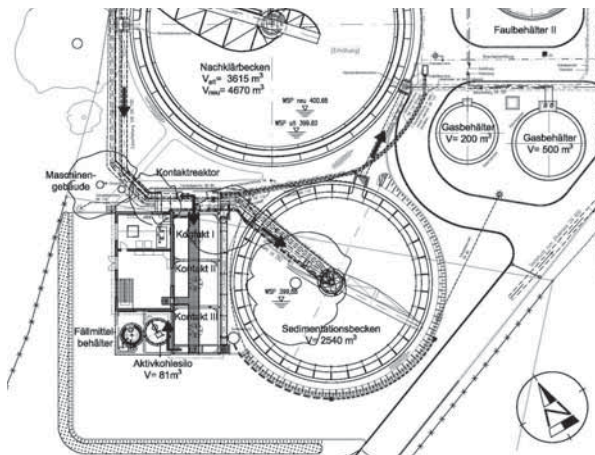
Lageplanausschnitt der Adsorptionsstufe der Kläranlage Kressbronn
